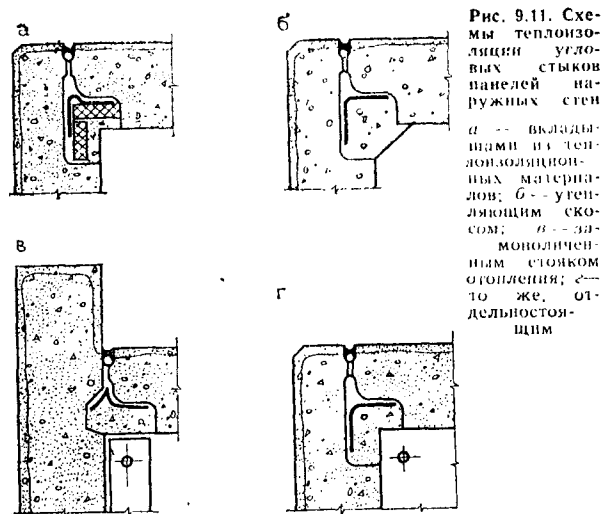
Схемы теплоизоляции угловых стыков панелей наружных стен
